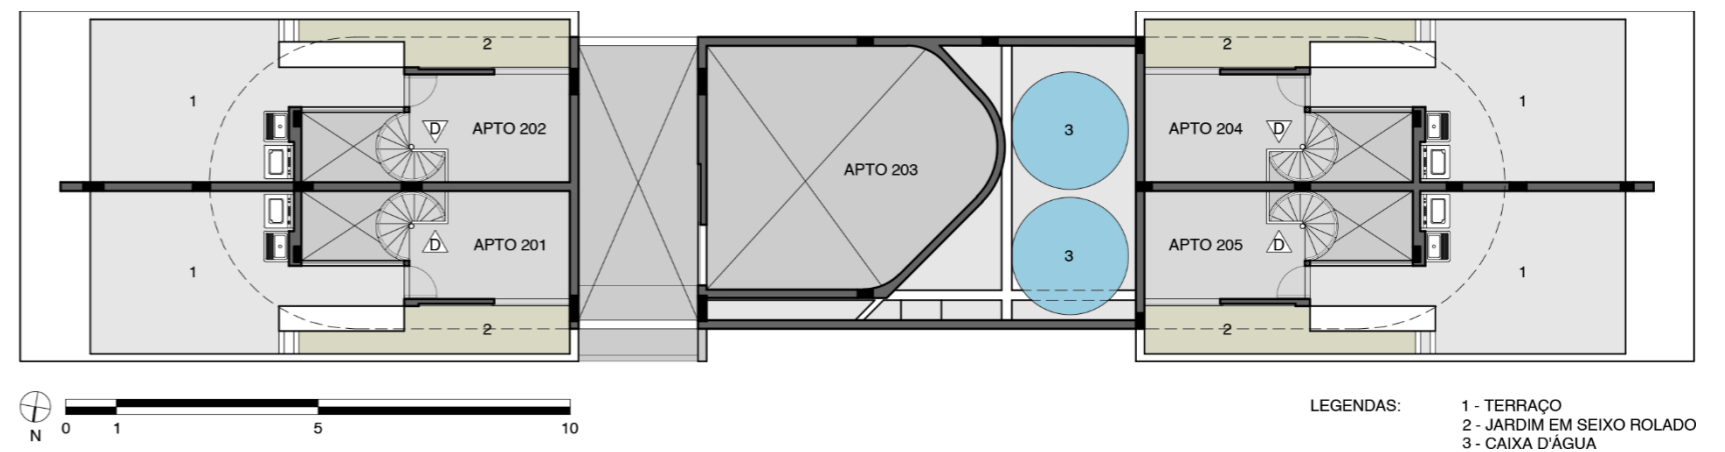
Planta do quinto pavimento dos Estúdios Capelinha
